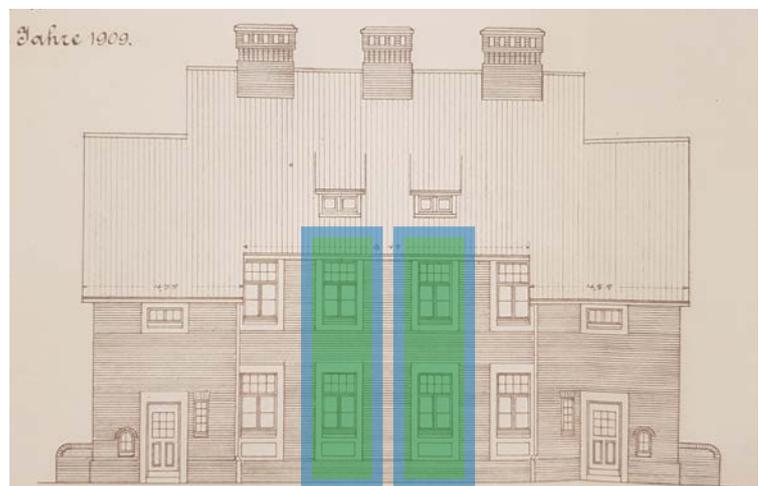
Haustypen H1 - H4, favorisierte Fensterachse
